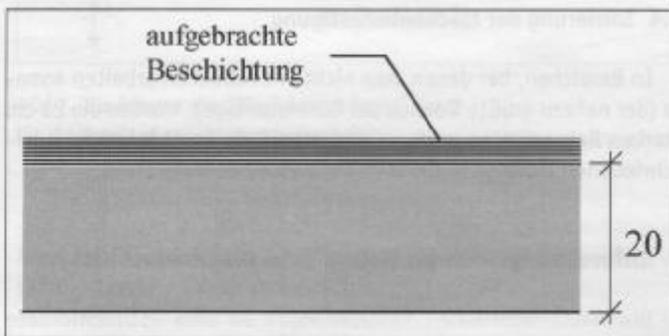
Sanierungsvariante 2 durch Aufbringen eines Beschichtungssystems
